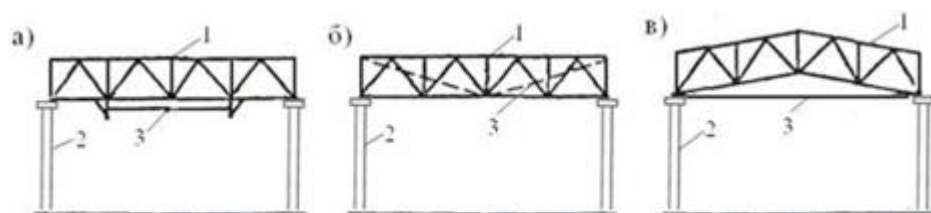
Усиление стропильных ферм путем установки преднапряженных затяжек: а) – при расположении вдоль нижнего пояса фермы; (б) и (в) – то же, в плоскости фермы при креплении затяжек в верхних и нижних опорных узлах фермы: 1 – усиливаемая ферма; 2 – колонна; 3 – затяжка
